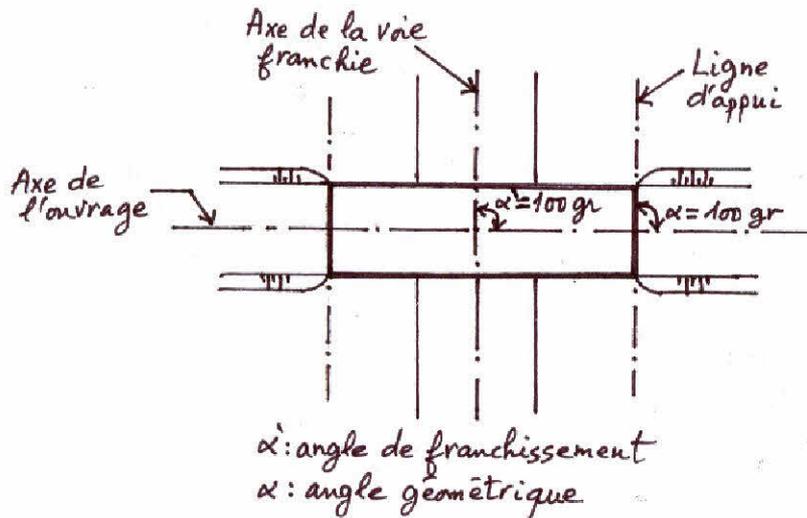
Vue en plan d'un pont droit en géométrie et en franchissement.
